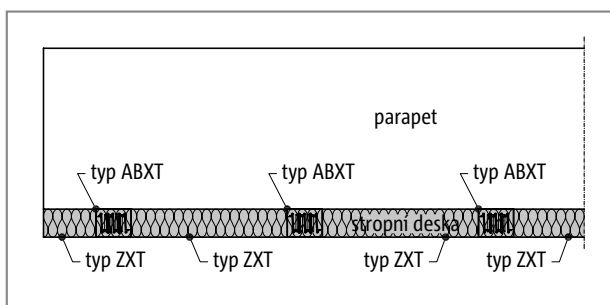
Schöck Isokorb® typ ABXT - svislé zabudování: Půdorys, uložení parapetu resp. atiky na stropní desce
